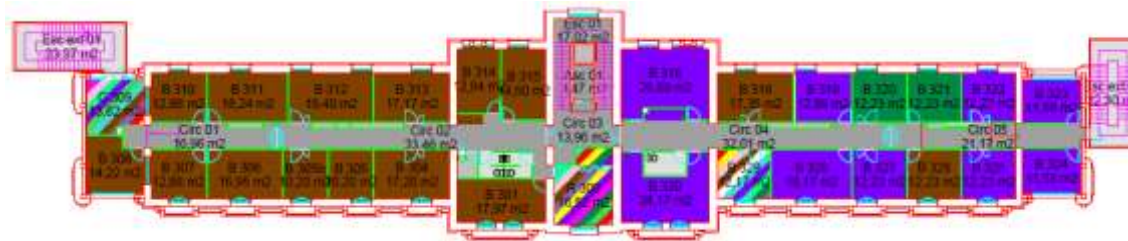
Plan du R+3 pavillon TAILLEFER – plan d'implantation 2020
